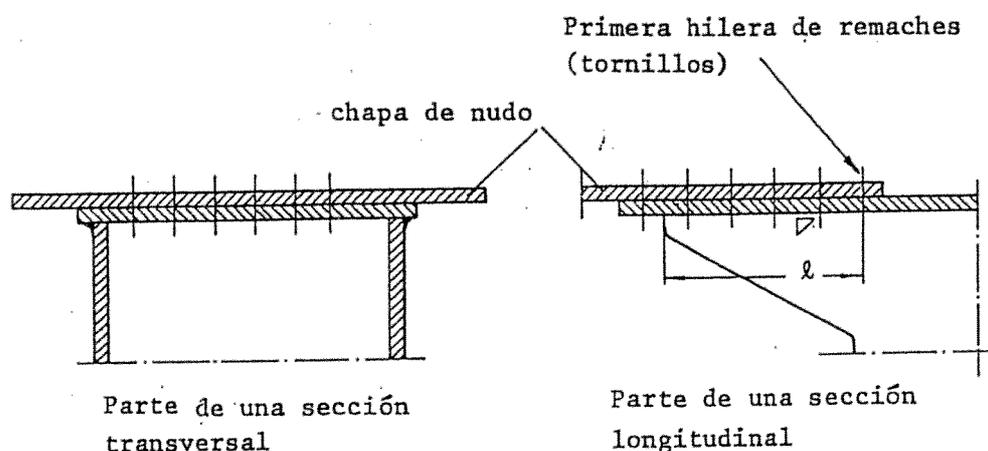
Longitud de la soldadura en un empalme remachado o atornillado de elementos soldados de una sección compuesta
